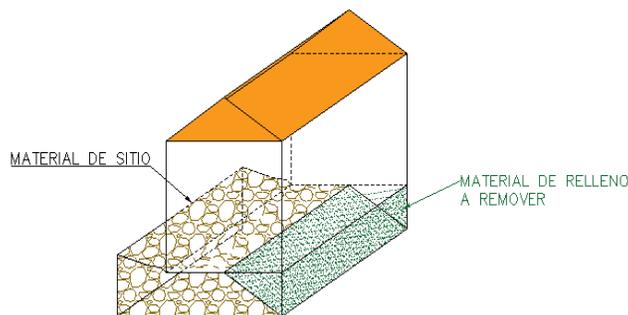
Esquema de vivienda con un 25 % de relleno.
